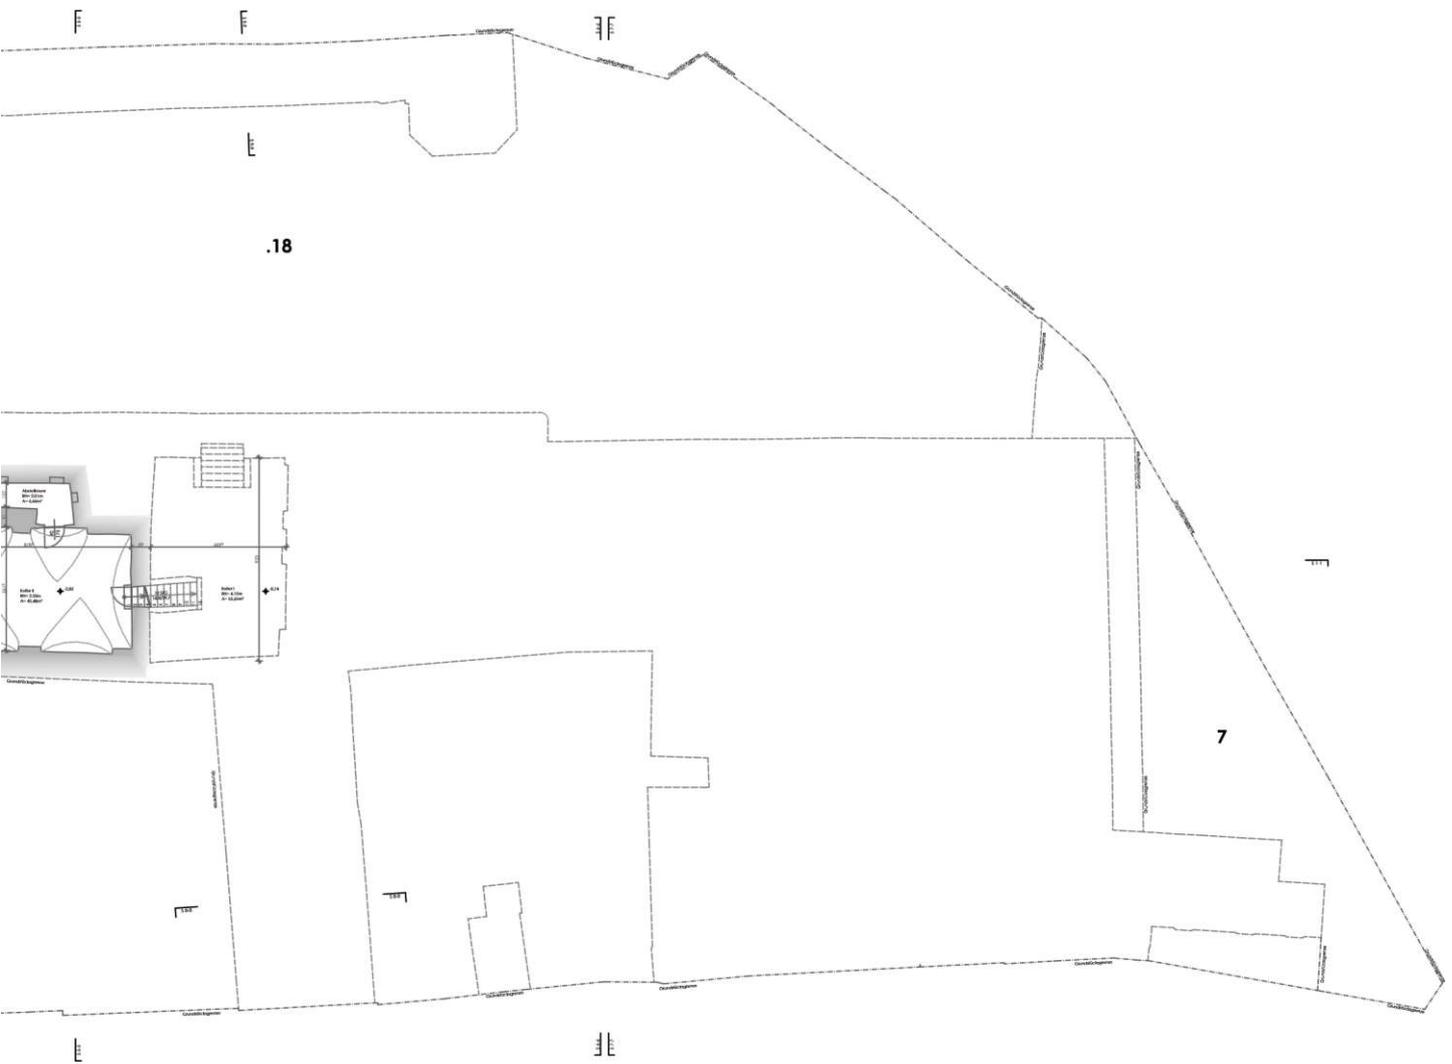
Bestandsplan Grundriss Kellergeschoss-Übersichtsplan
